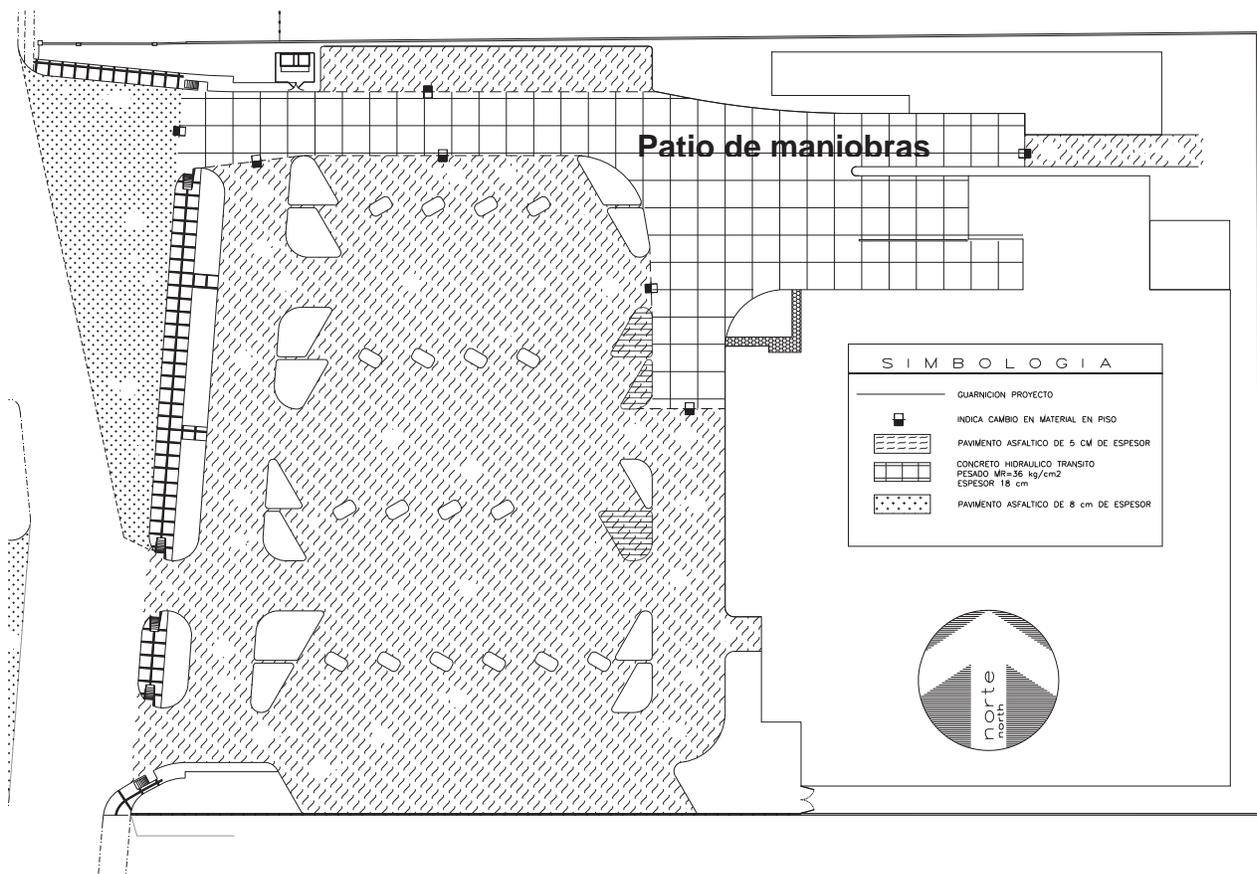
Detalle en el que se aprecia el área de pavimento hidráulico, tomado del plano C - 09.
